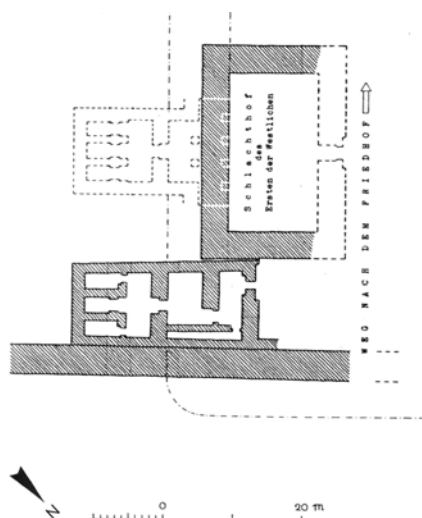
Grundriss Chontamenti-Heiligtums/Abydos
